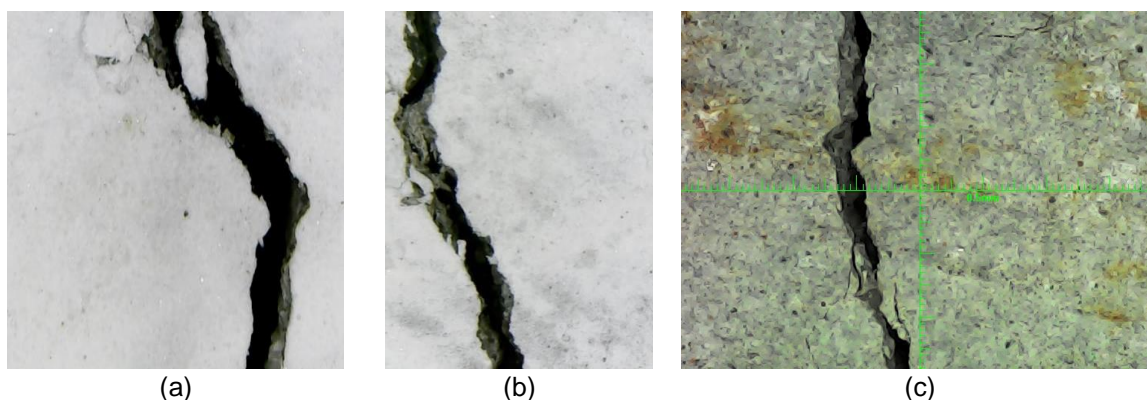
Abertura das fissuras das vigas observadas durante os ensaios de flexão (Autores).
